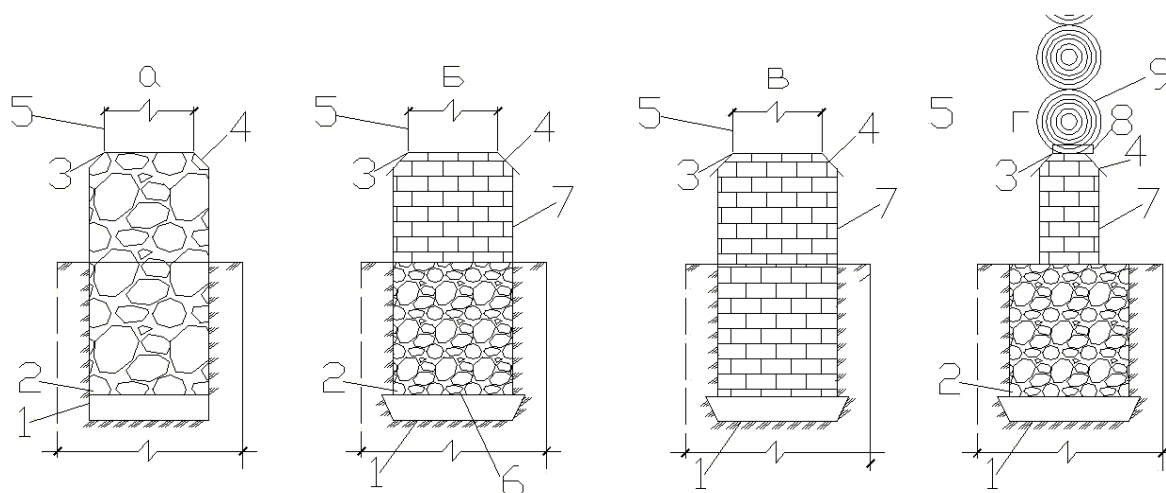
Варианты столбчатых и каменных и бутобетонных фундаментов:
